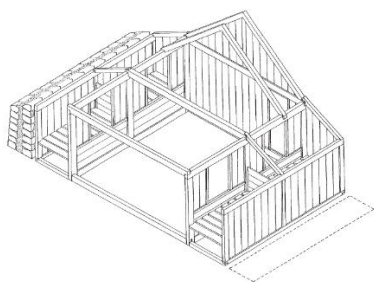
Casa tradicional das Ilhas Faroé - Paredes leves com vigas de base e topo ligadas a pilares de canto com paredes exteriores de pedra e turfa (Schjelderup & Storsletten, 1999).
